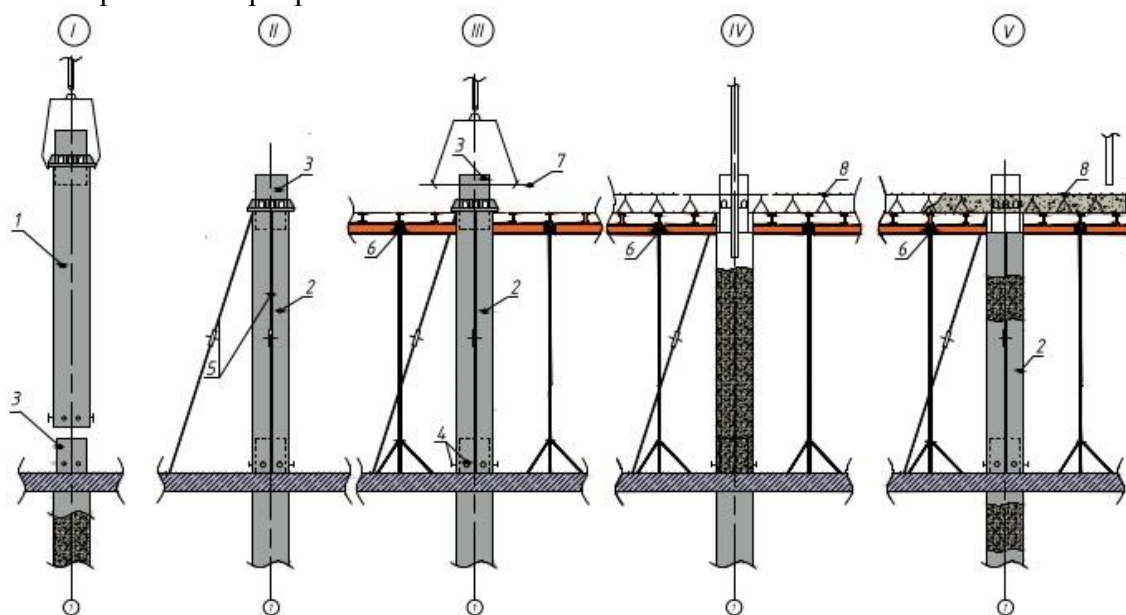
Технологическая схема последовательности возведения несущих конструкций каркаса здания с колоннами из трубобетона:
